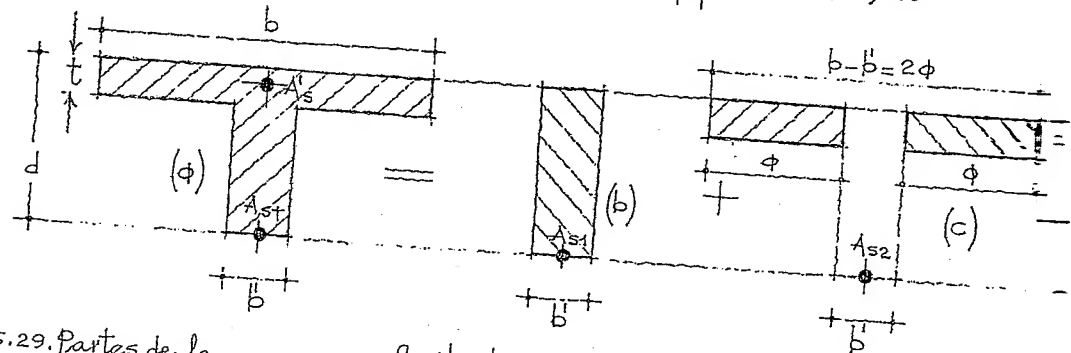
Partes de la losa trabajando en conjunto con la viga "T", (c).
